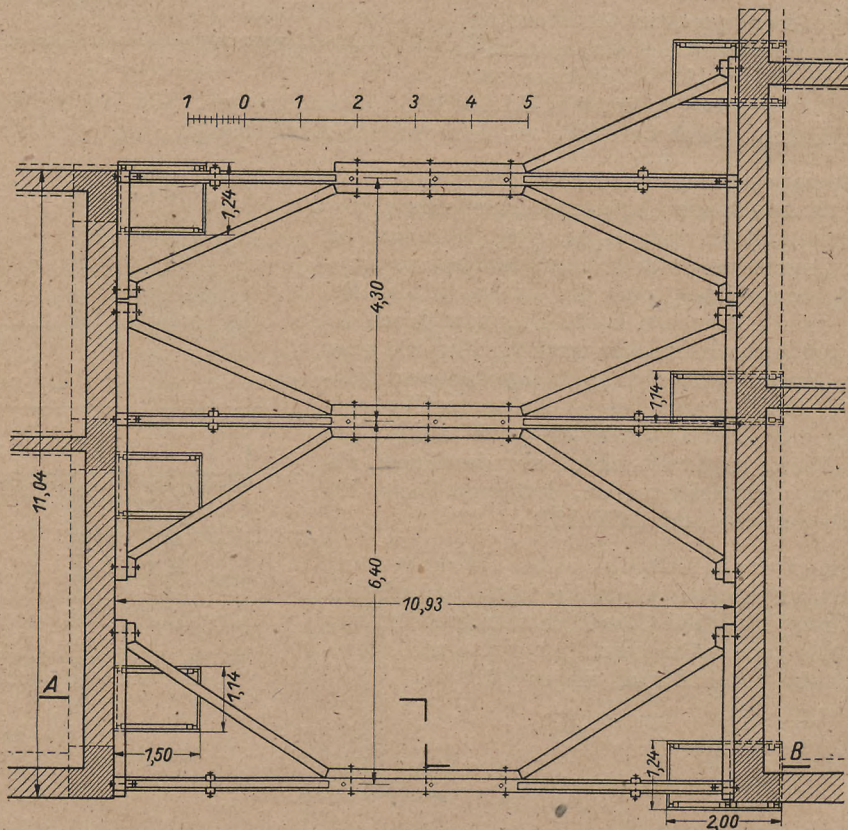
Sicherung der Nachbarhäuser beim Einbau eines Hauses mit tieferer Gründungssohle (Grundriß)
